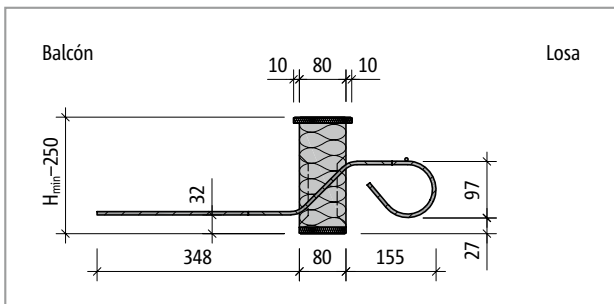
Schöck Isokorb® T tipo Q-Z-V1 hasta Q-Z-V5: Sección del producto
